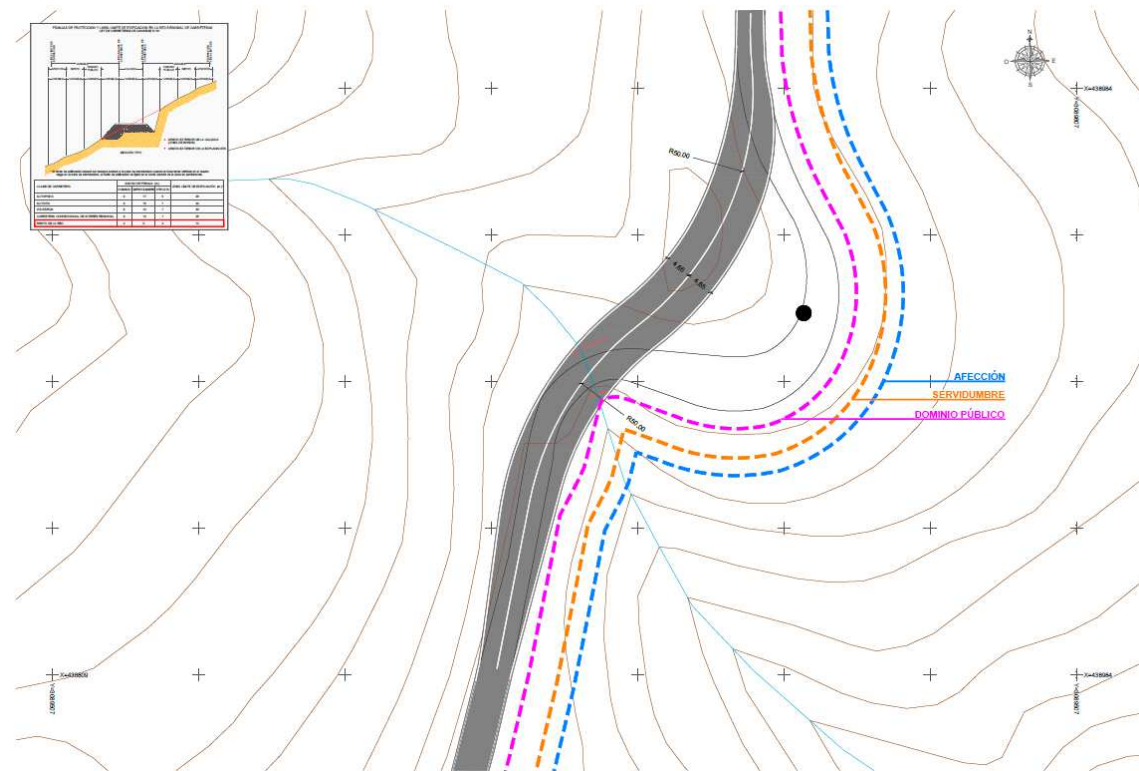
Primera alternativa planteada. Fuente: Elaboración propia.
